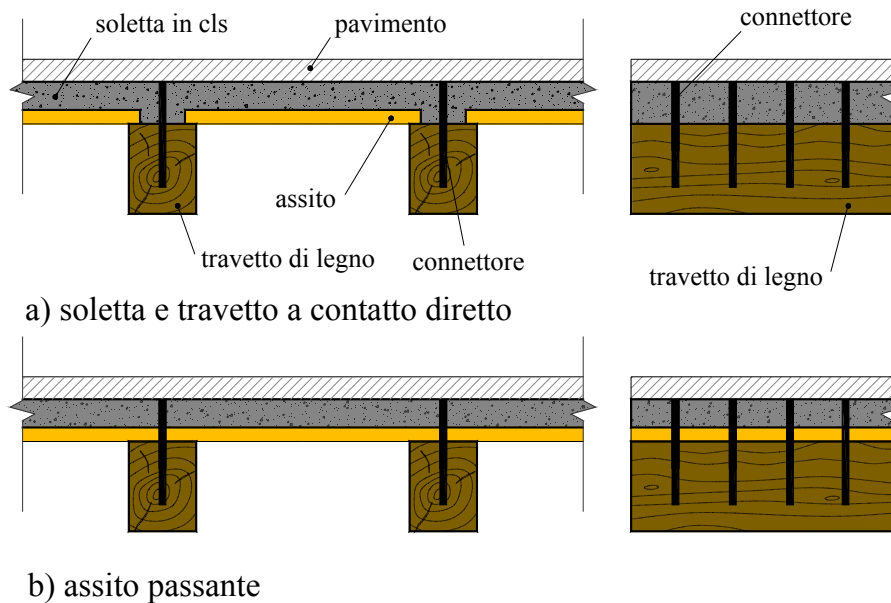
Sezione tipo di un solaio in legno irrigidito con lastra in calcestruzzo.
